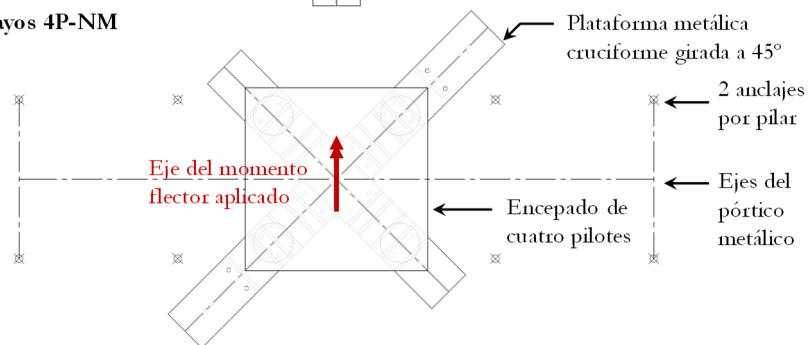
Plano de la configuración del ensayo para encepados de cuatro pilotes
